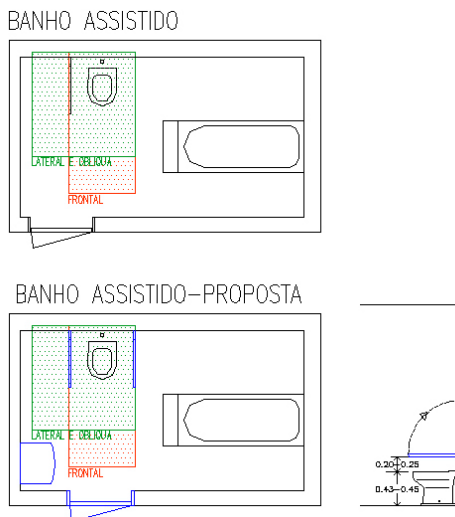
Instalação sanitária do banho assistido e proposta de alteração a azul
